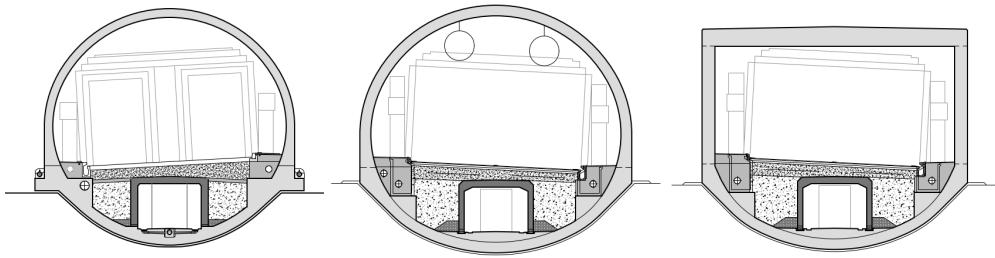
Sections transversales de la galerie de Malleray et du tunnel de Susten.
